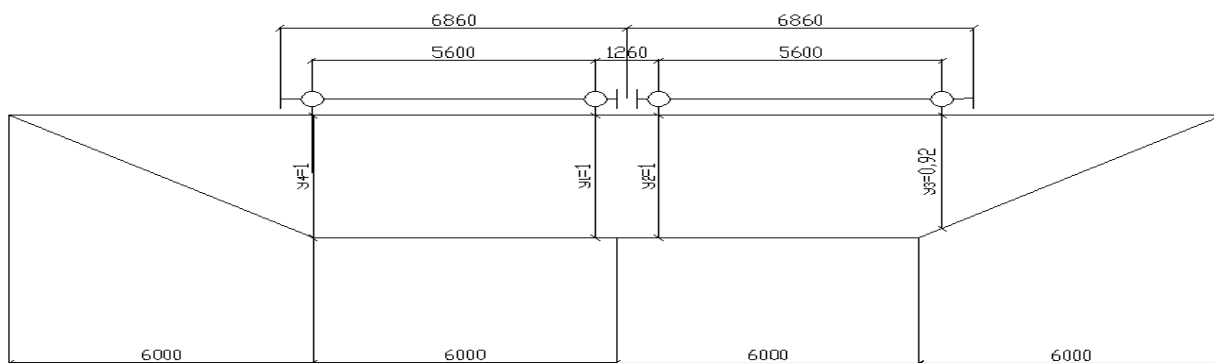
Схема к расчету колонны на крановую нагрузку
